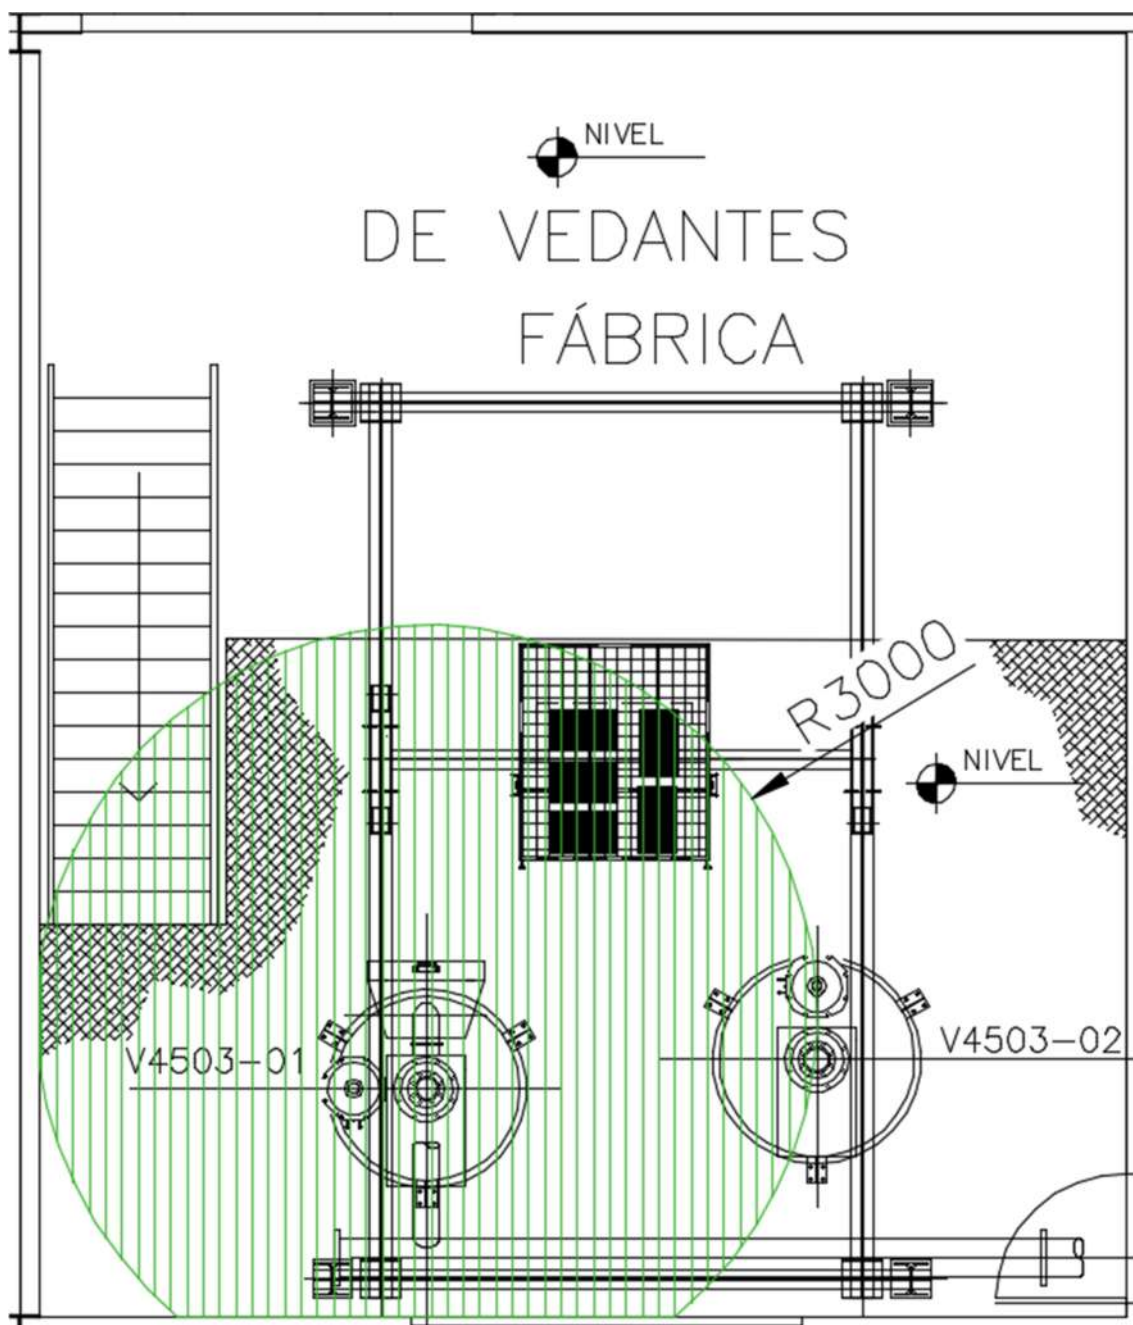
Planta de Classificação de Área- Vista superior da planta de Vedantes
